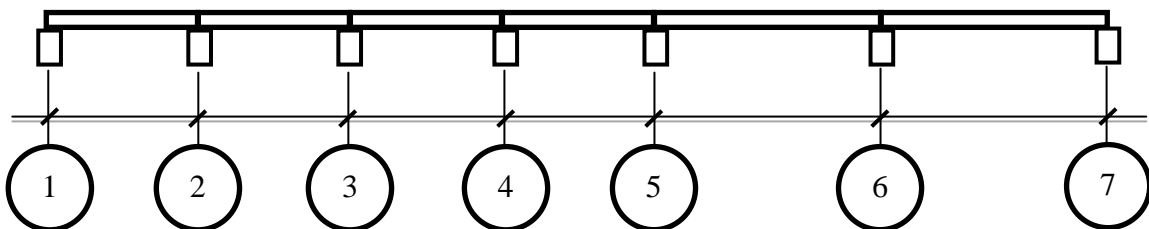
Poutrelles du type-1 du plancher corps creux du Rez-de-Chaussée
